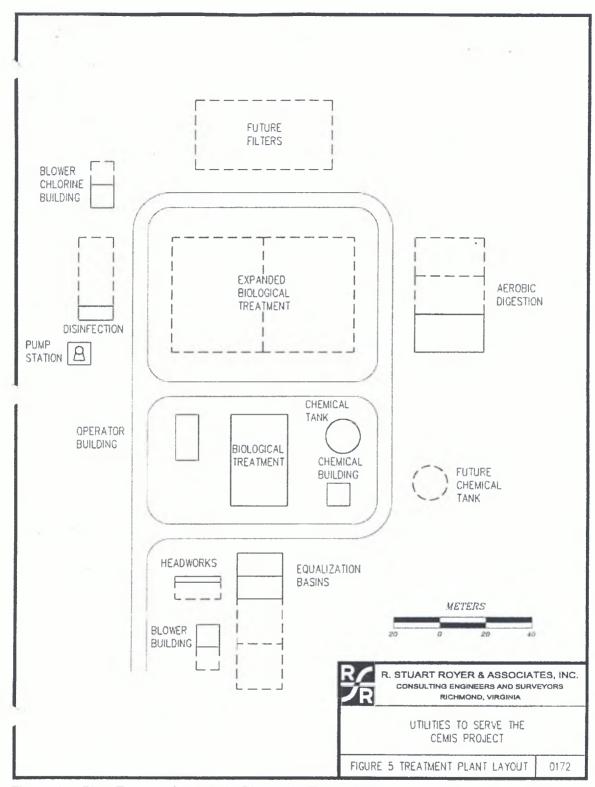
Plan Esquemático de la Planta de Tratamiento
